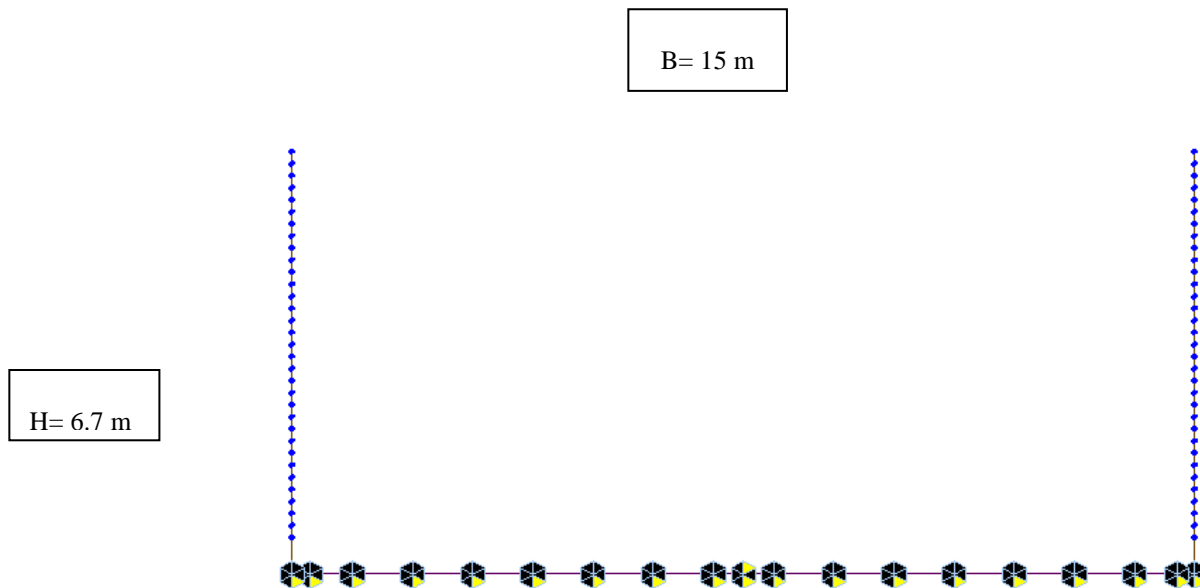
1° modello strutturale su letto di molle con vincolo centrale allo spostamento orizzontale
